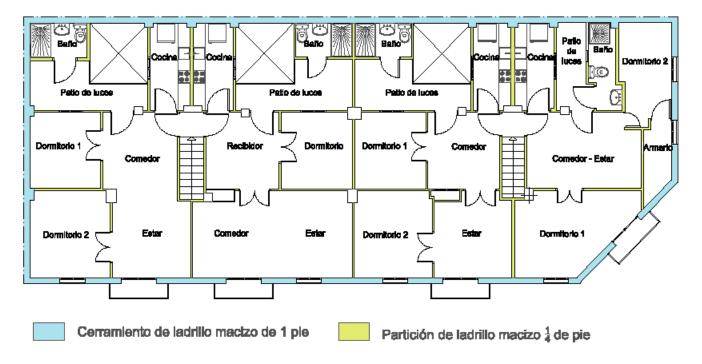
Esquema de tipologías de tabiquería en planta primera. Elaboración propia
